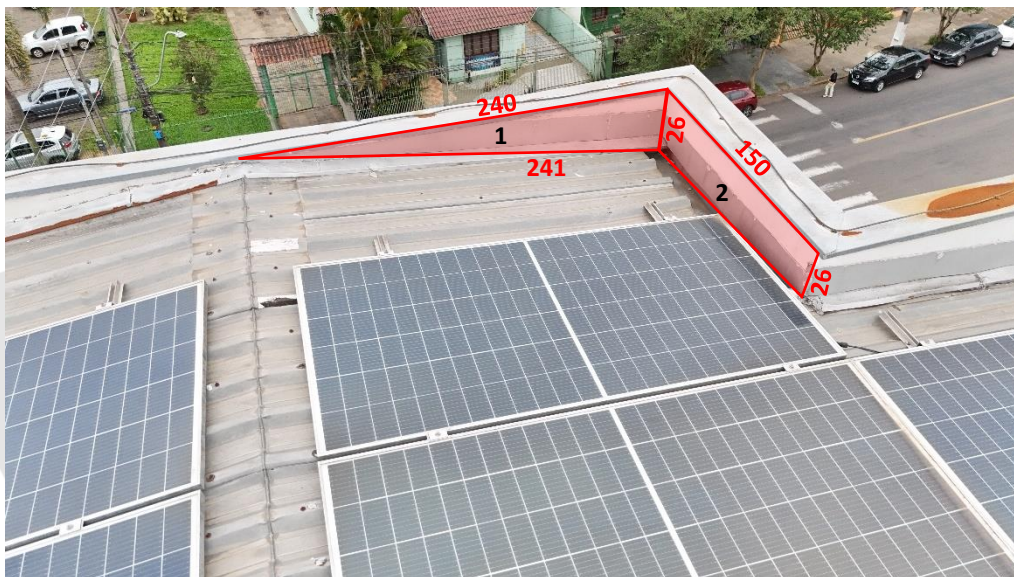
Medidas das platibandas 1 e 2 em cm.
